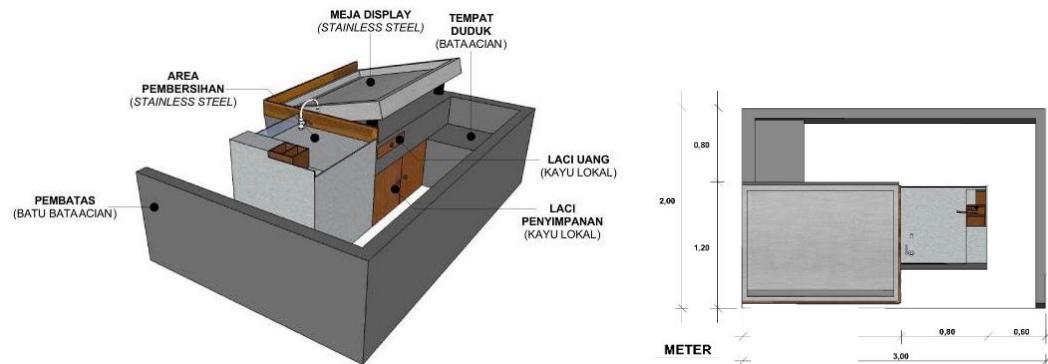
3D Bangunan Pengolahan Ikan
